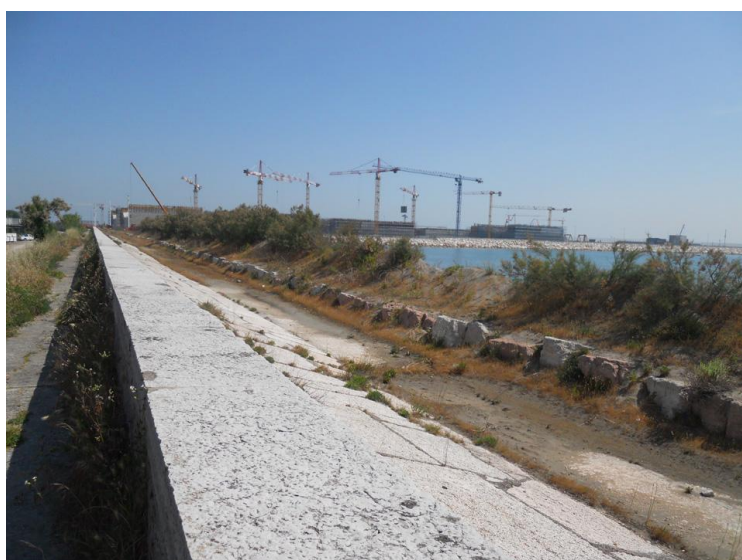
Santa Maria del Mare: vasca e vegetazione delle zone umide, vista dei cantieri dal murazzo.
